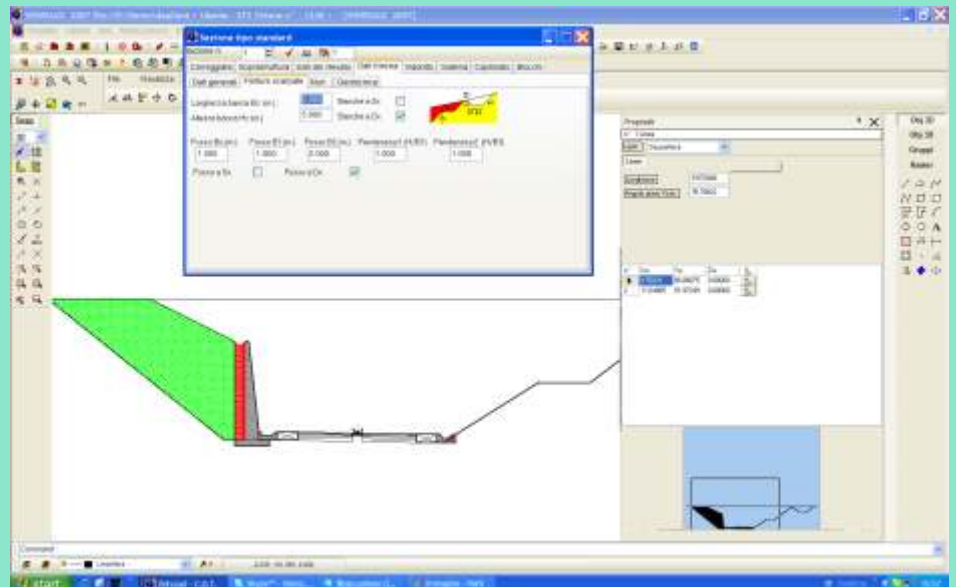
Sezione stradale tipo in trincea con riempimento e opere d'arte
